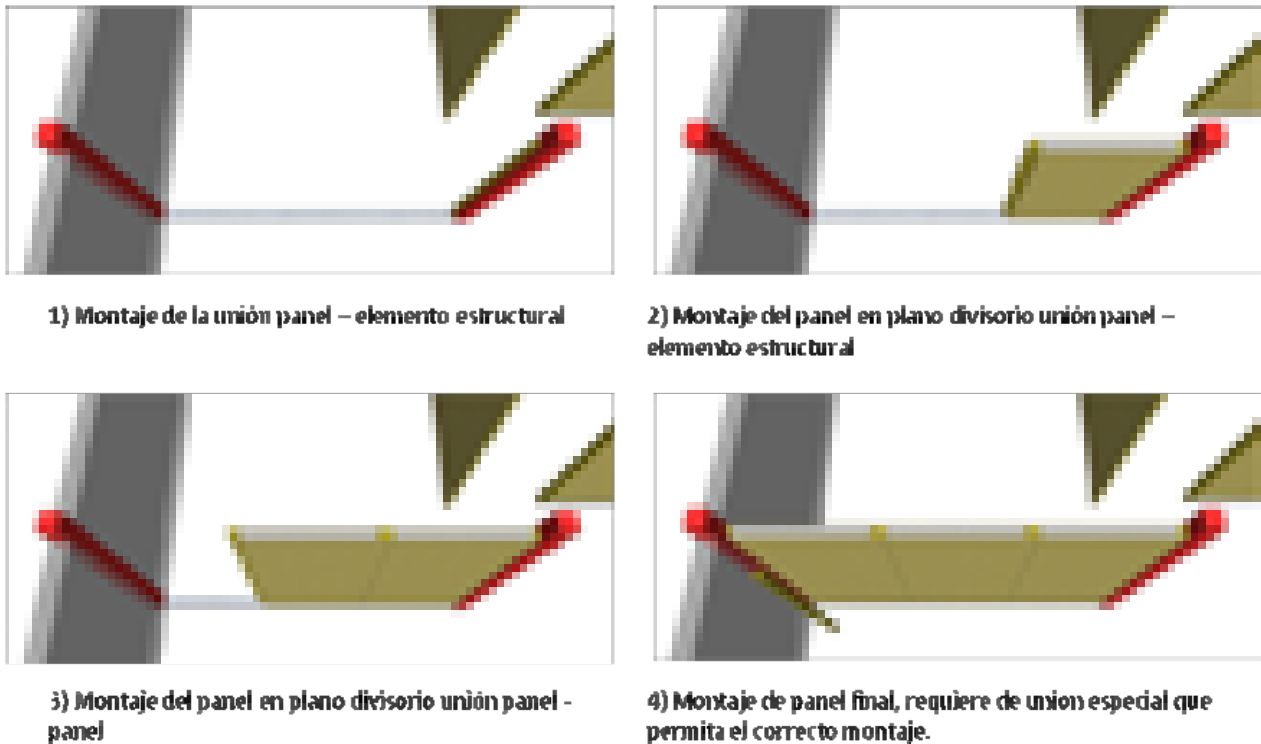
Unión de desmontaje panel-estructura. Fuente: Elaboración propia, 2013.
